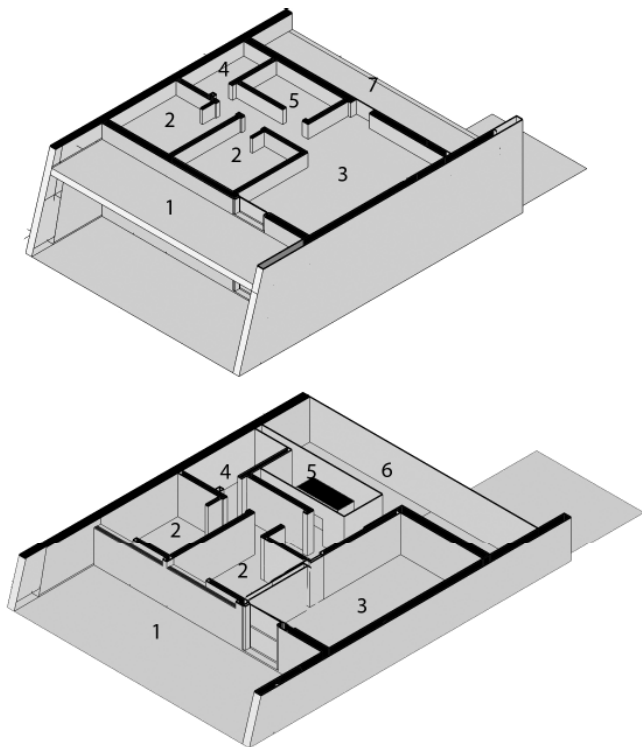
Planta baixa do H-18 unidade do pavimento térreo e do superior. Legenda: 1) Varanda, 2) Dormitório, 3) Sala, 4) Banheiro, 5) Cozinha, 6) Área de serviço, 7) Corredor de Circulação da área comum. Fonte: Autor, 2018.
